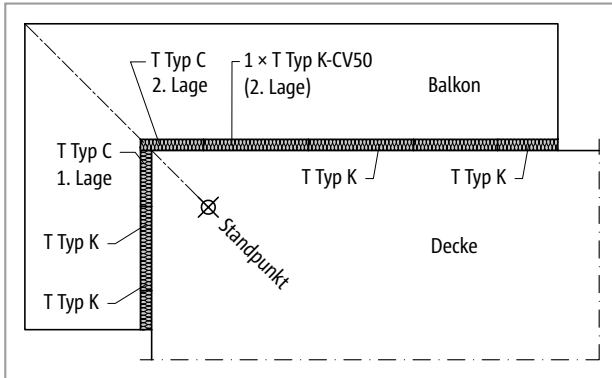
Schöck Isokorb® T Typ C: Balkon mit Außenecke frei auskragend
